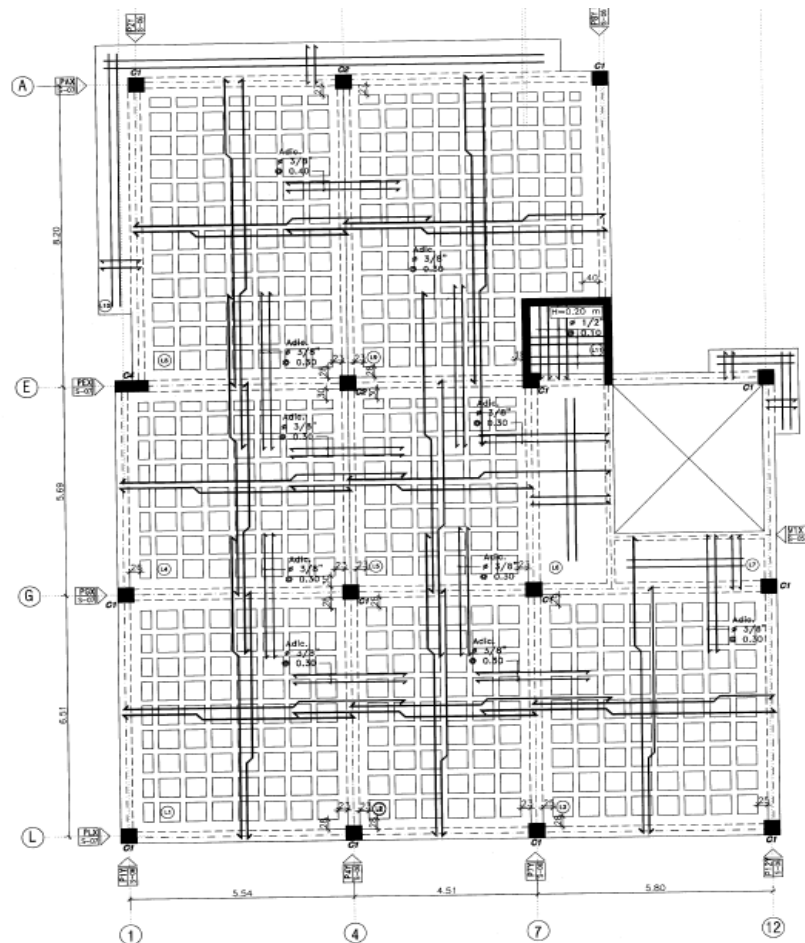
Planta Estructura de Techo Edificio Madame Curie Banco Ademi
